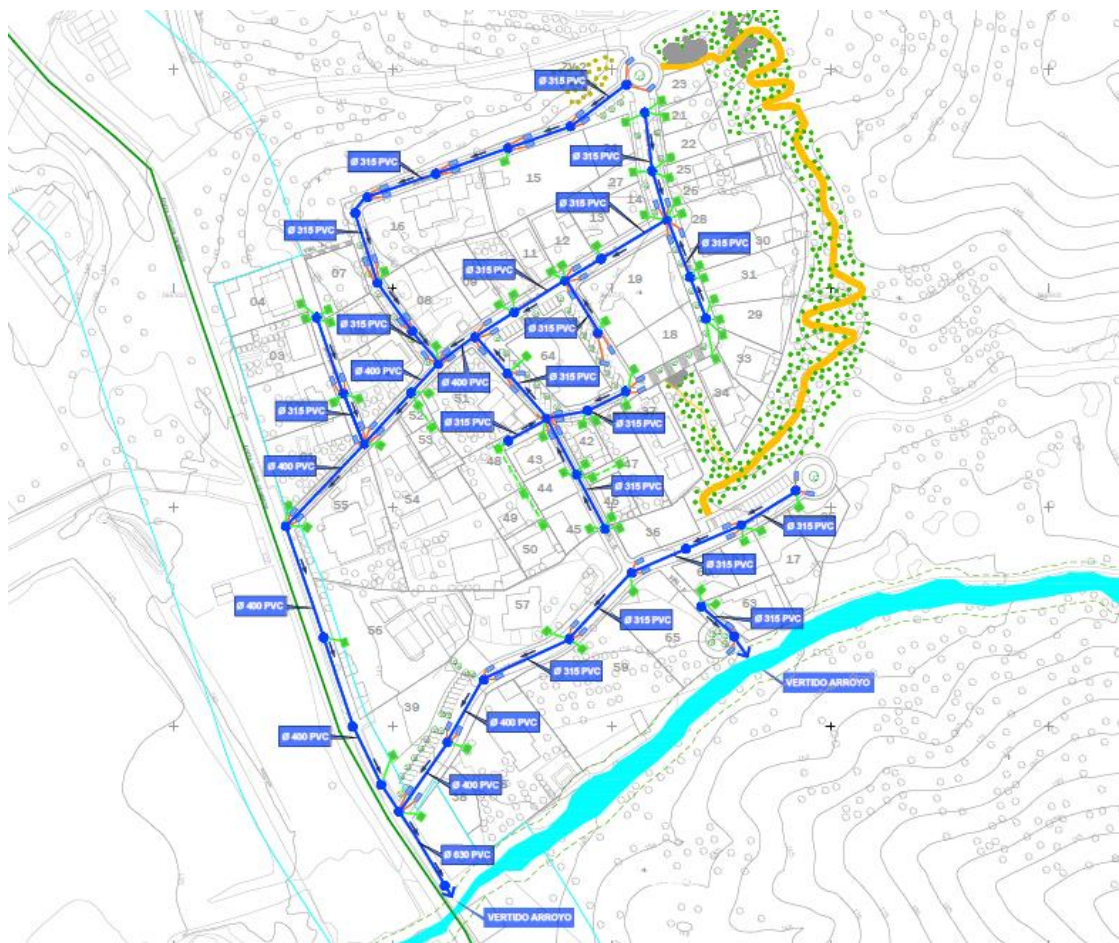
Detalle de la nueva red de saneamiento de aguas pluviales y vertido a vaguada existente.
